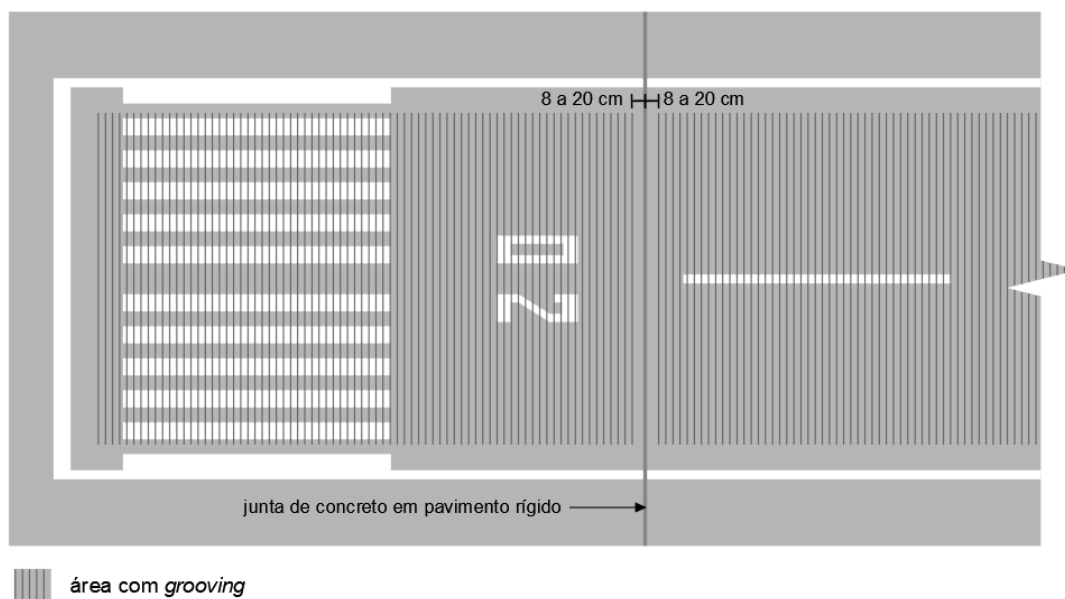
Distanciamento do *grooving* em relação às juntas em pavimento rígido.
